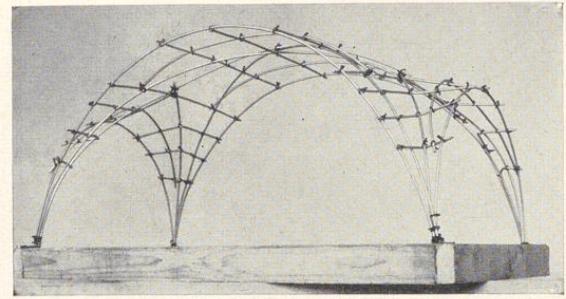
Rundeisengerippe eines Tonnengewölbes mit Stichkappen
